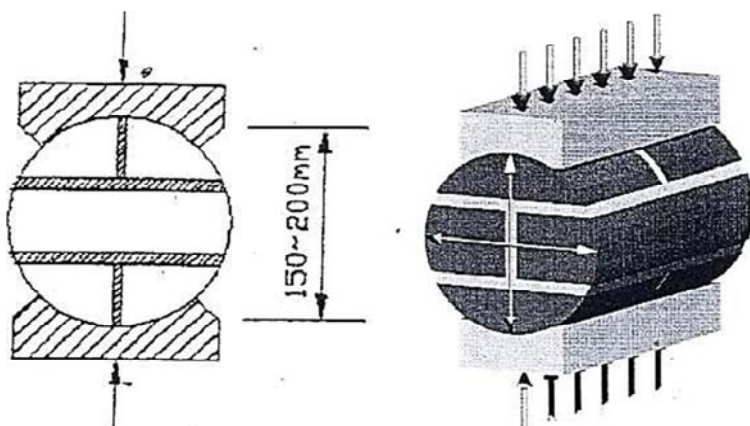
Схема испытания цилиндрических образцов кладки на сжатие
